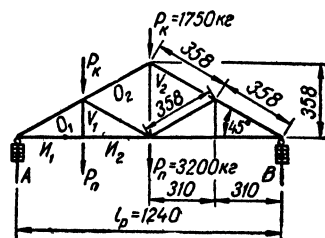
Расчетная схема фермы и геометрические размеры.
